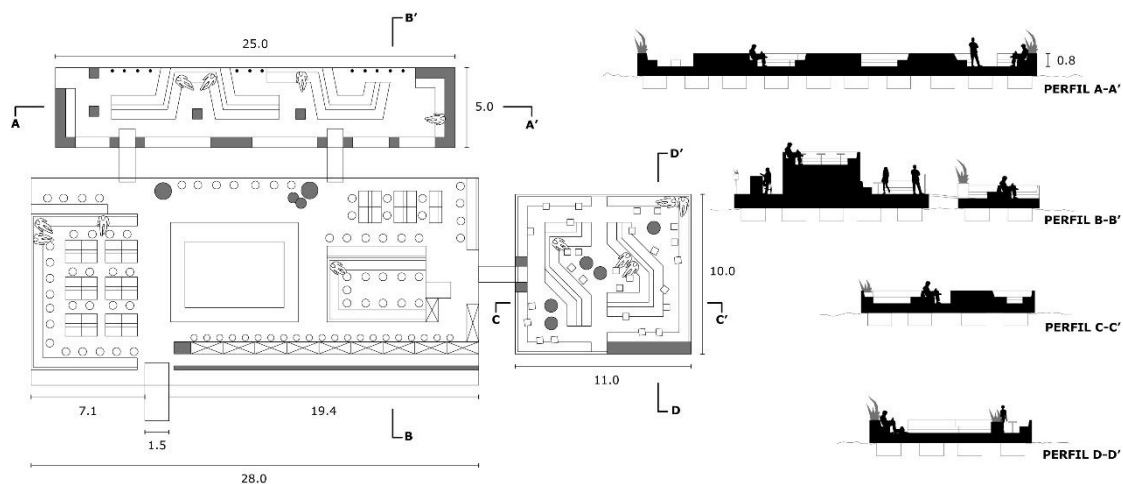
Detalhes da expansão do Mälarpaviljongen.
